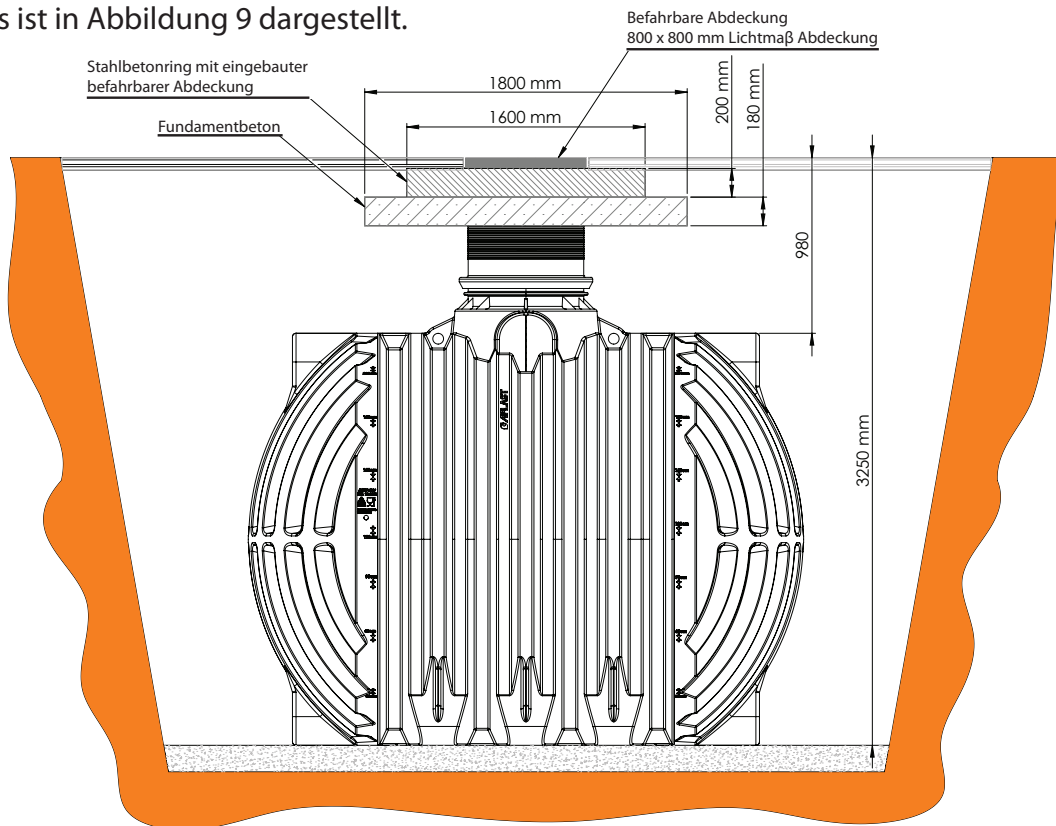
Einbau des Behälters unter befahrbare Flächen für Fahrzeuge mit einer Achslast von bis zu 2,2 t
